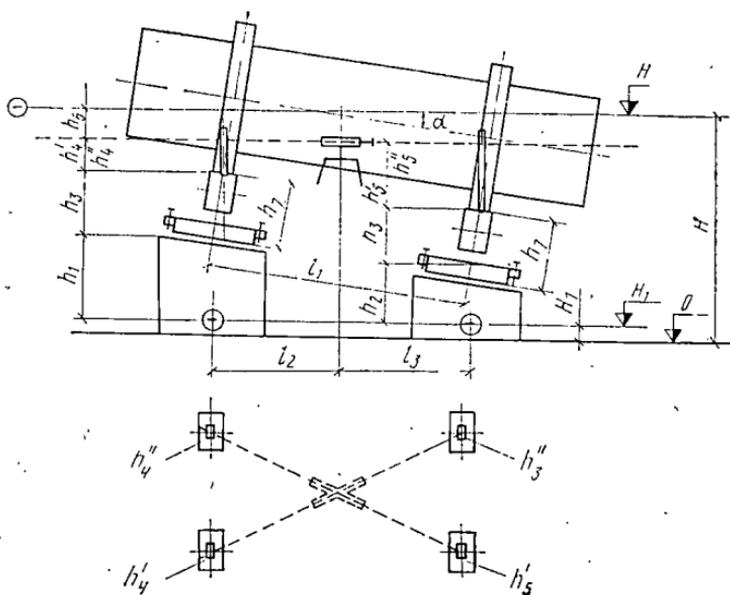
Схема выверки взаимного расположения станций (установки корпуса)
